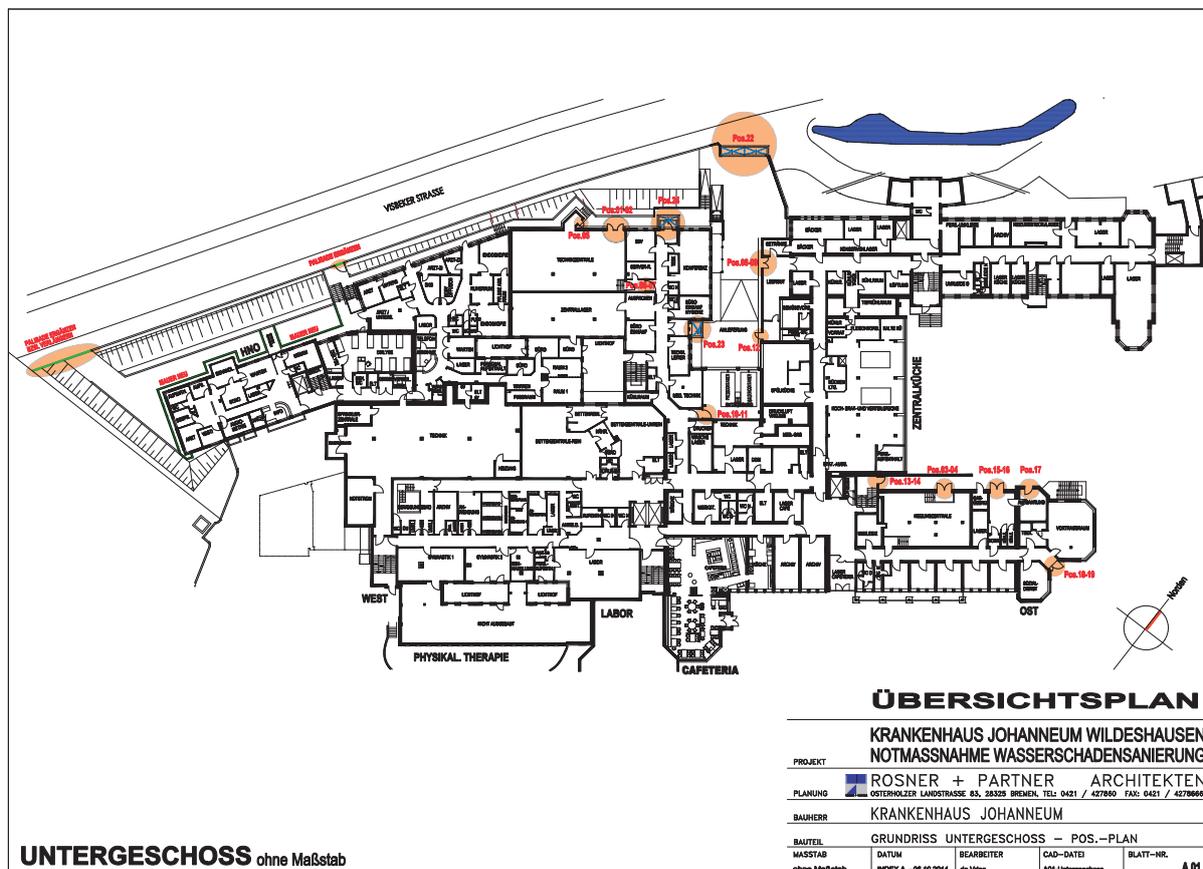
Grundriss des Krankenhauses mit rot gekennzeichneten Maßnahmen des Schutzkonzeptes (Quelle: Johanneum)
